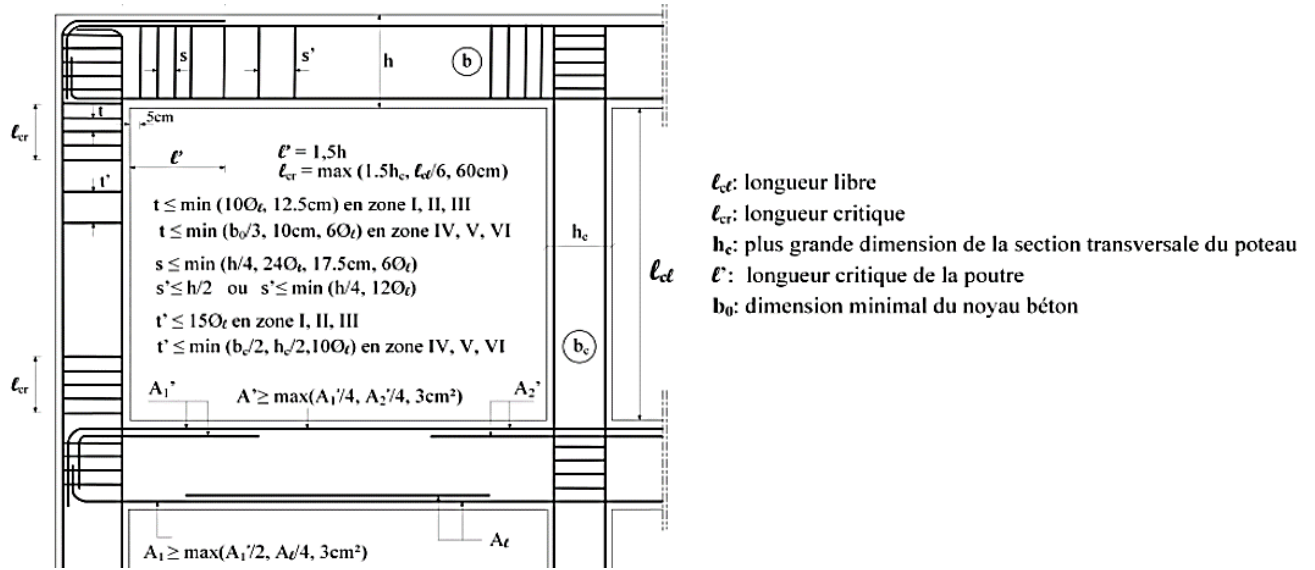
18:Croquis explicatif des armatures transversales (RPA2024)
